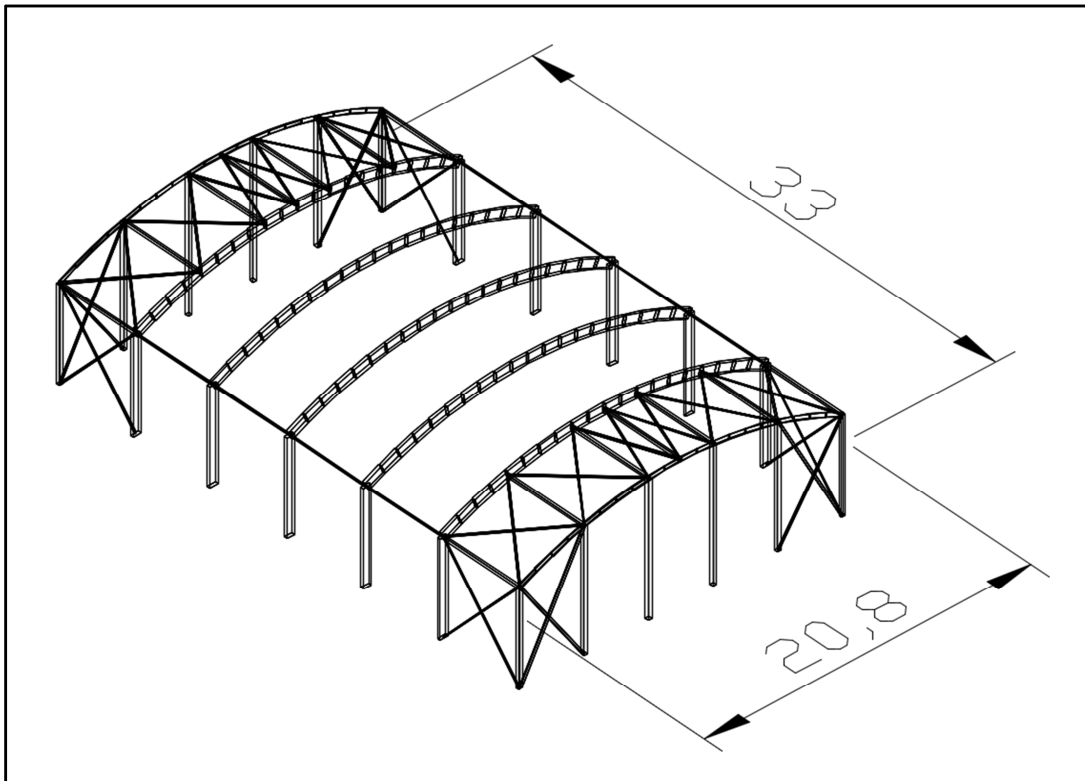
Vista 3D cubierta. Fuente: CYPE 3D. Unidades en metros (m)
